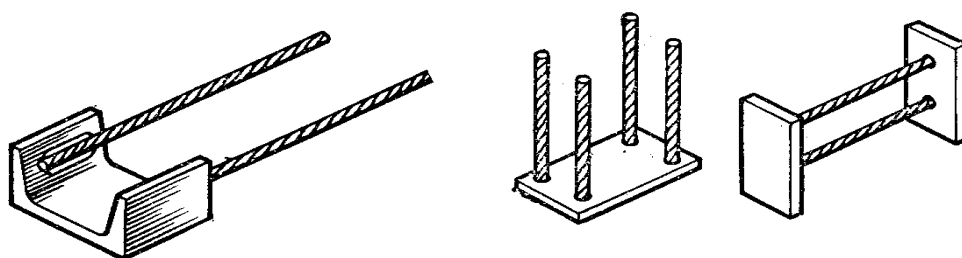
Закладные детали для сборных железобетонных конструкций
